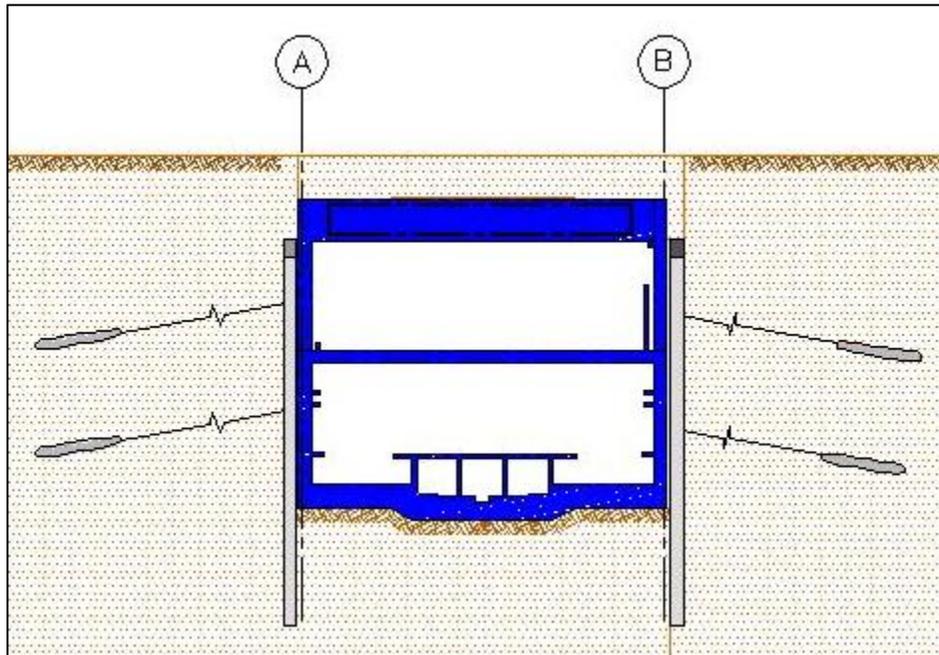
Estructura de contención muros colados anclados.
